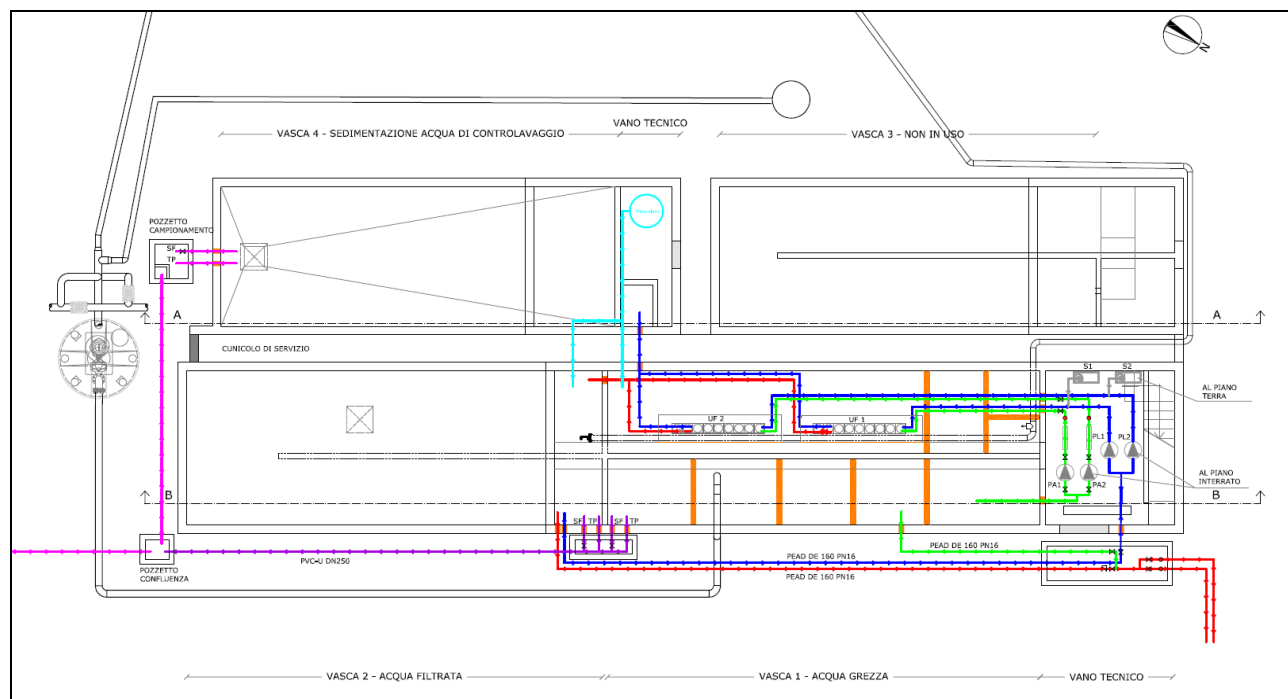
Stralcio planimetrico dell'impianto di potabilizzazione in progetto.
